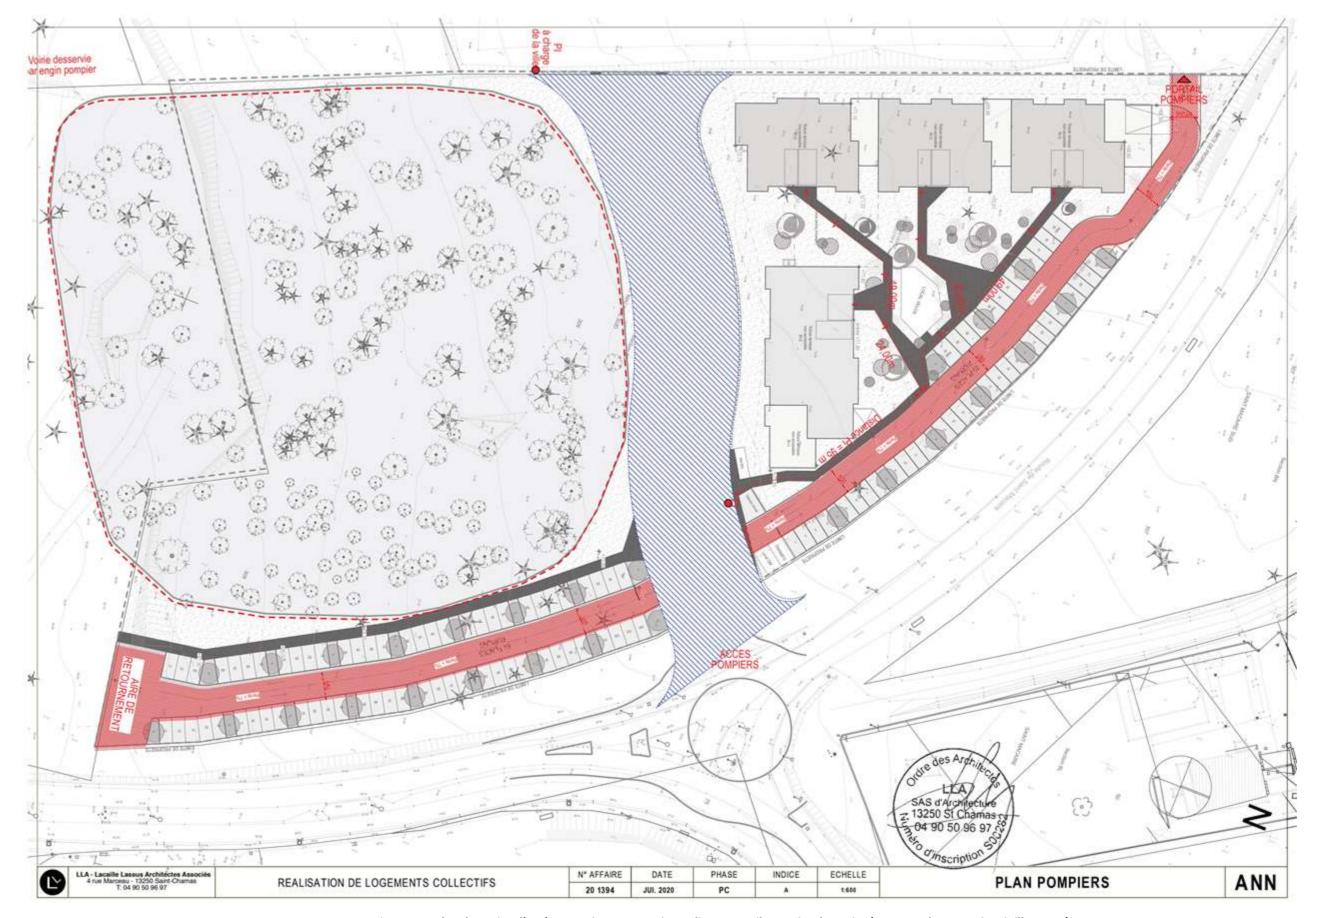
Plan des voies d'accès pompier, poteaux incendie et portail pompier du projet (Source : Plan pompiers juillet 2020)
